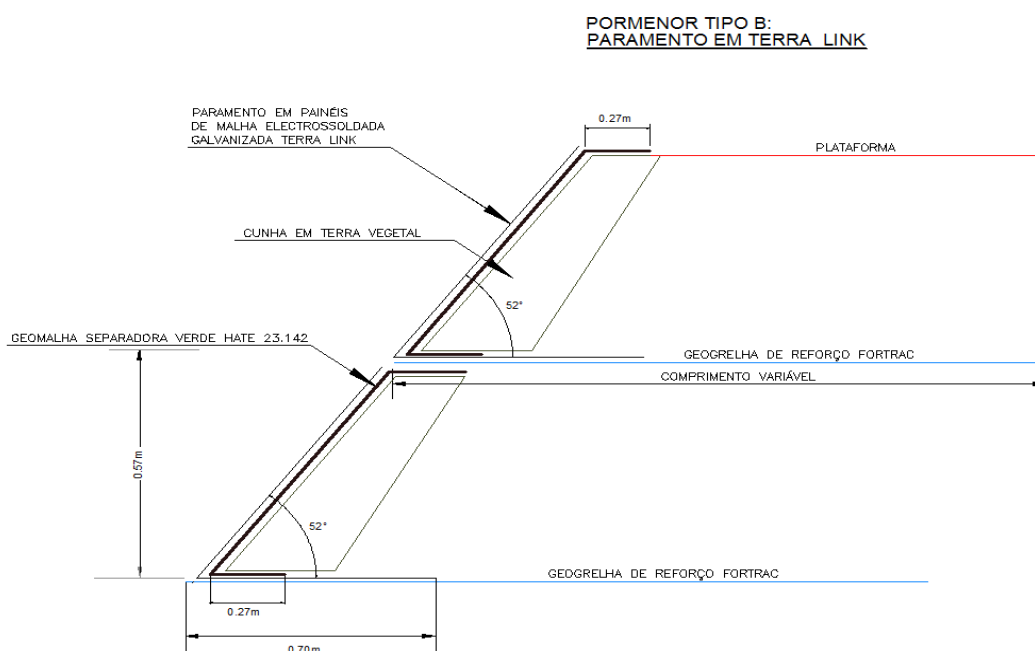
Detalle de muro reforzado con geomallas y cara vista TERRA LINK con inclinación de 52°
